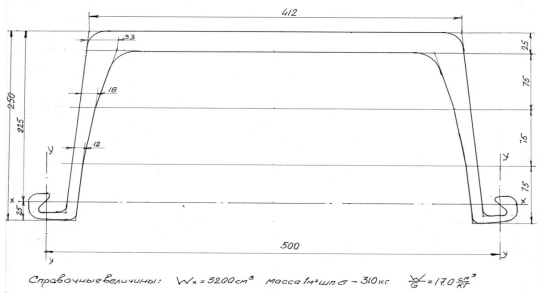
Профиль шпунтовой сваи высокой несущей способности Ларсен-7Н / Fig. 2. Profile sheet piles of high bearing capacity Larssen-7N
